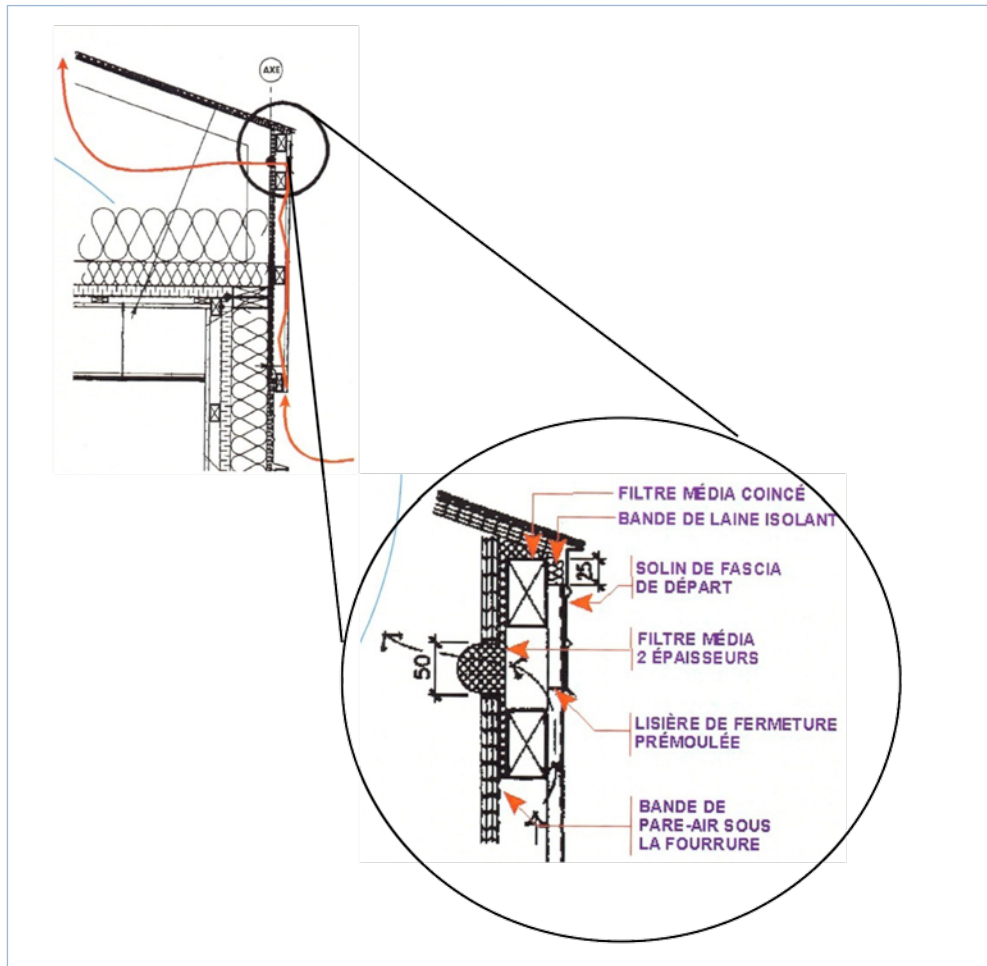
VENTILATION D'UN VIDE SOUS TOIT / SOURCE : SHQ
